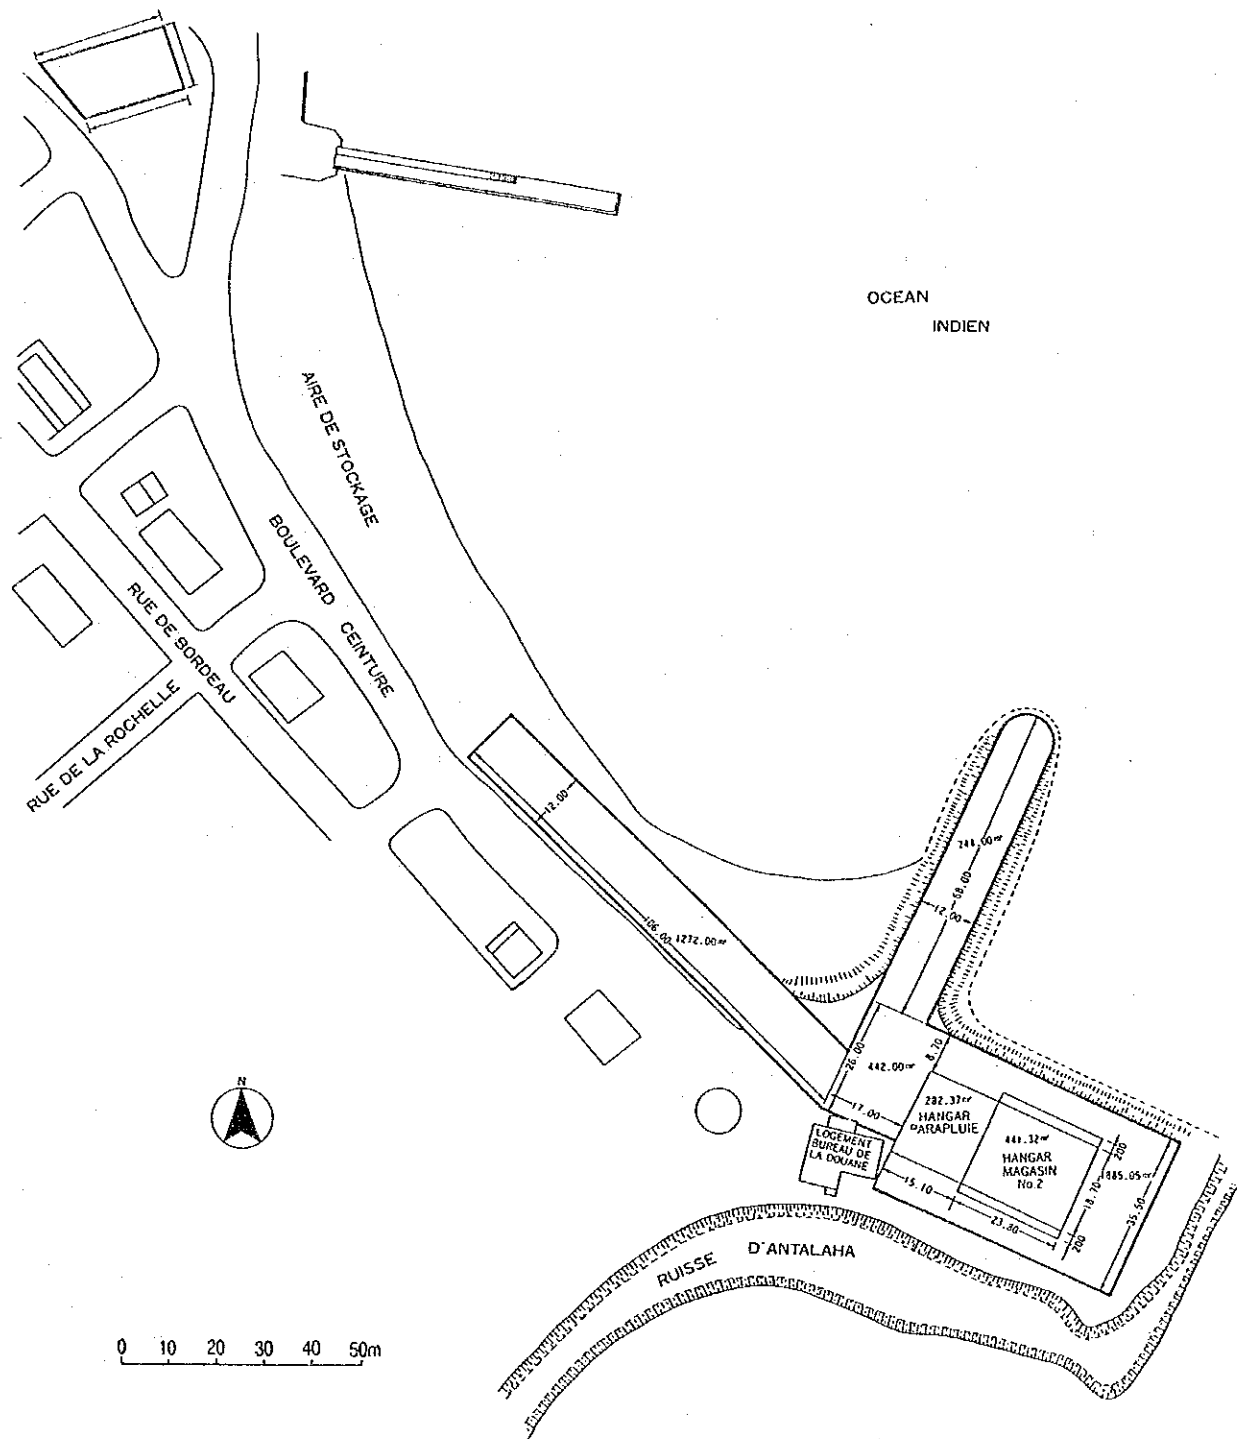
Plan d'Implantation du Port d'ANTALAHA
